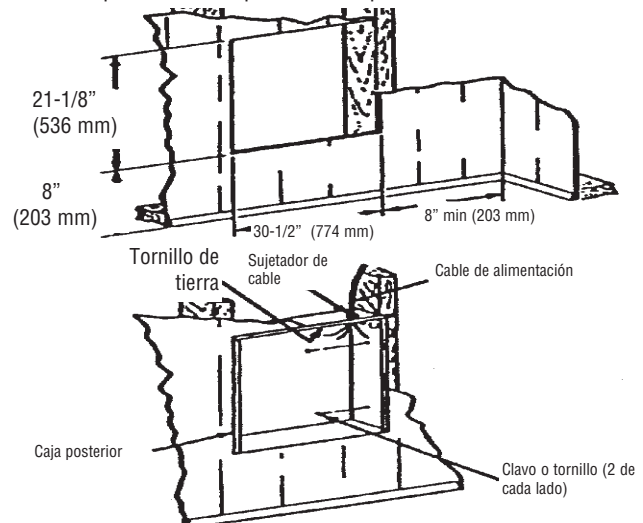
Instalación empotrada de la caja posterior en una construcción existente
